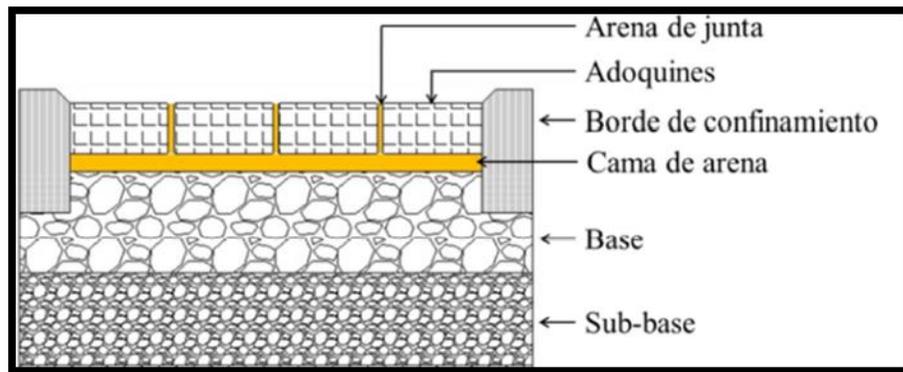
Elementos estructurales de un pavimento de adoquines
